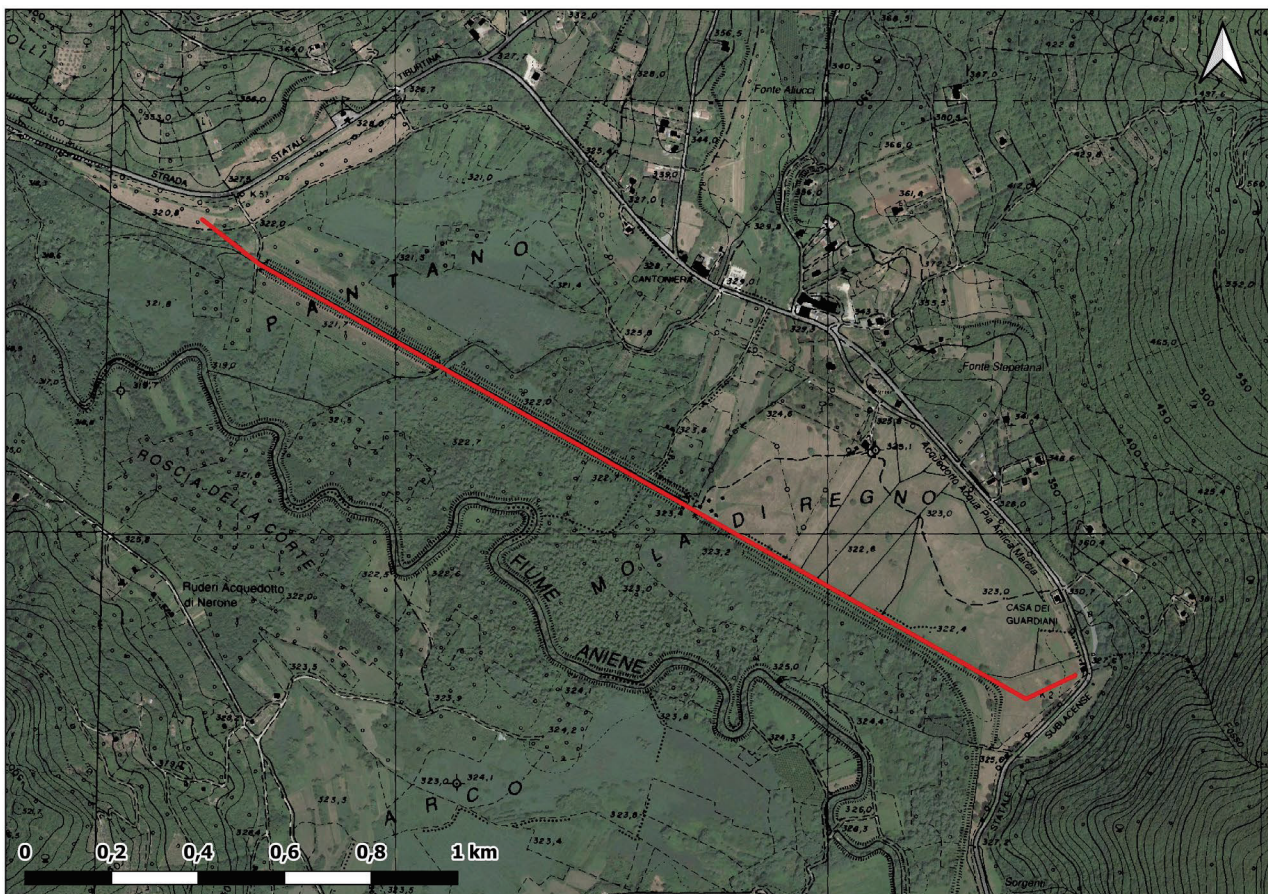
Planimetria di dettaglio del tratto comune iniziale TC1.
